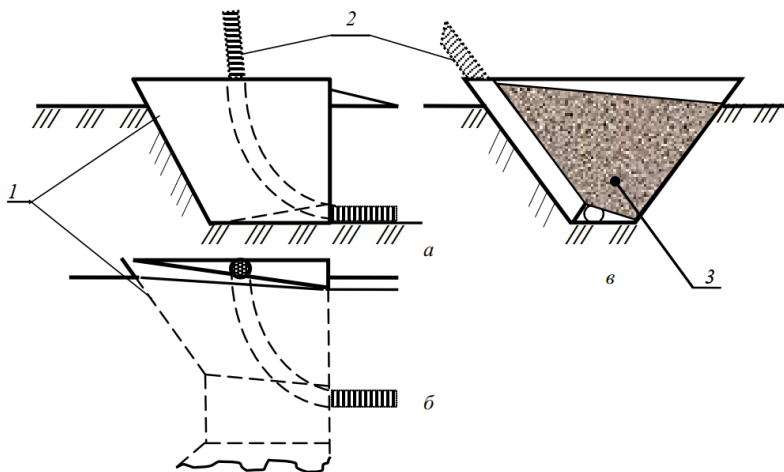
Схема работы V-образного плуга (Δ-плуга): а – вид сбоку; б – вид сверху; в – вид спереди: 1 – режущие кромки плуга; 2 – дренажная труба; 3 – призма грунта
